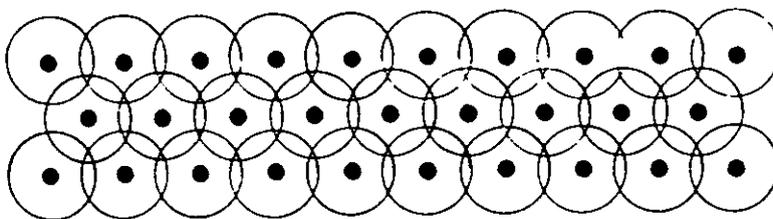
Patrón de barrenación en tresbolillo.
